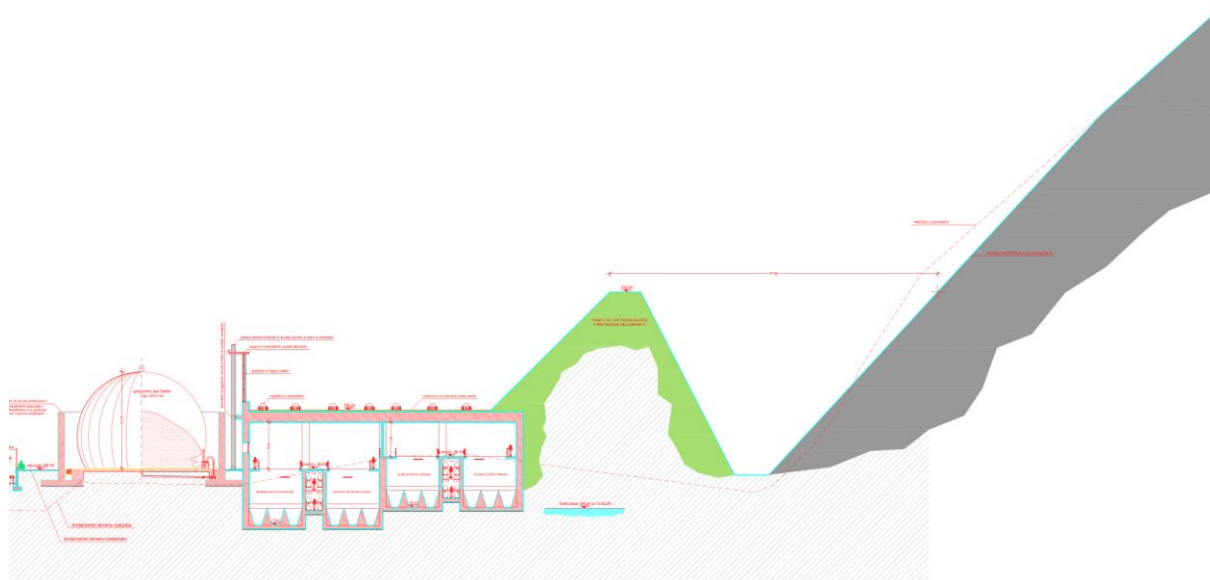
estratto delle planimetrie rappresentanti le sezioni dell'impianto, da questa immagine in evidenza il sistema tomo-vallo.
